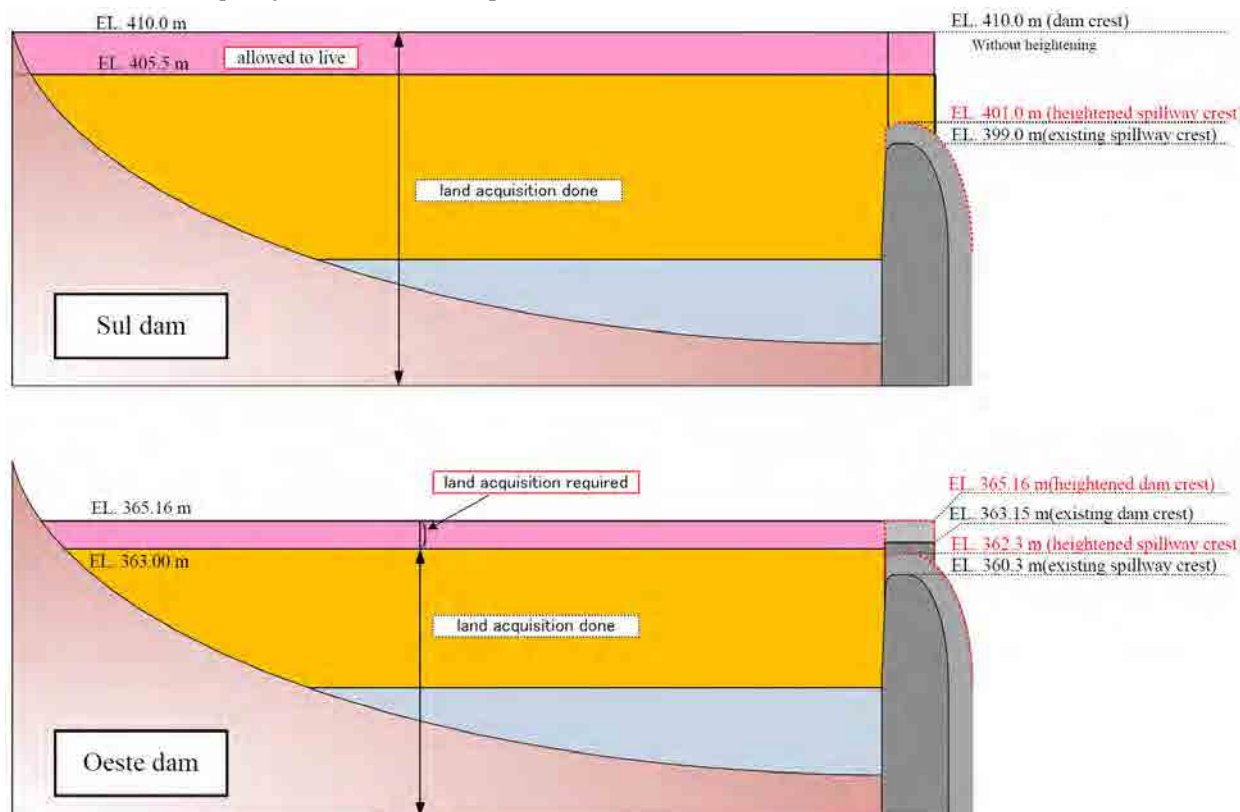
Elevação das Barragens após a Sobre-elevação das Barragens Sul e Oeste e Status da Posse da Terra
